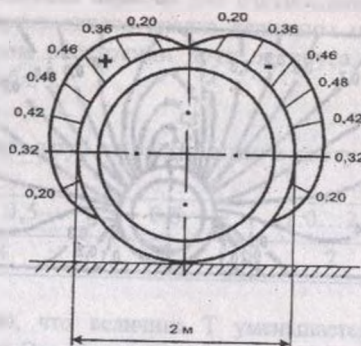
Эпюры радиального давления грунта на трубы двухниточной укладки.
